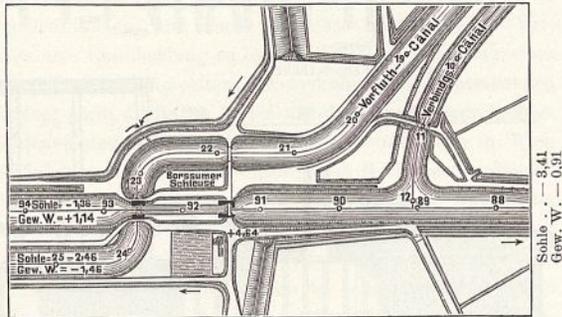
Lageplan der Borssumer Schleuse. 1:8000.
